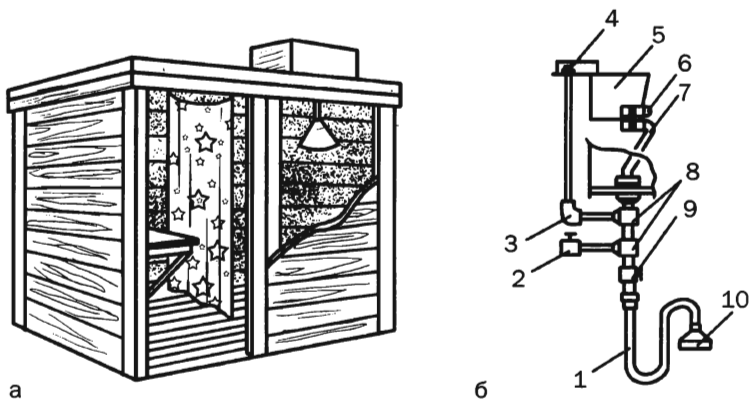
Устройство летнего душа (вариант 1): а — общий вид; б — оборудование для подачи воды; 1 — наконечник; 2 — патрубок; 3 — муфта; 4 — фиксатор; 5 — стенка бака; 6 — поплавок; 7 — гибкий шланг; 8 — тройник; 9 — вентиль; 10 — рассекатель
